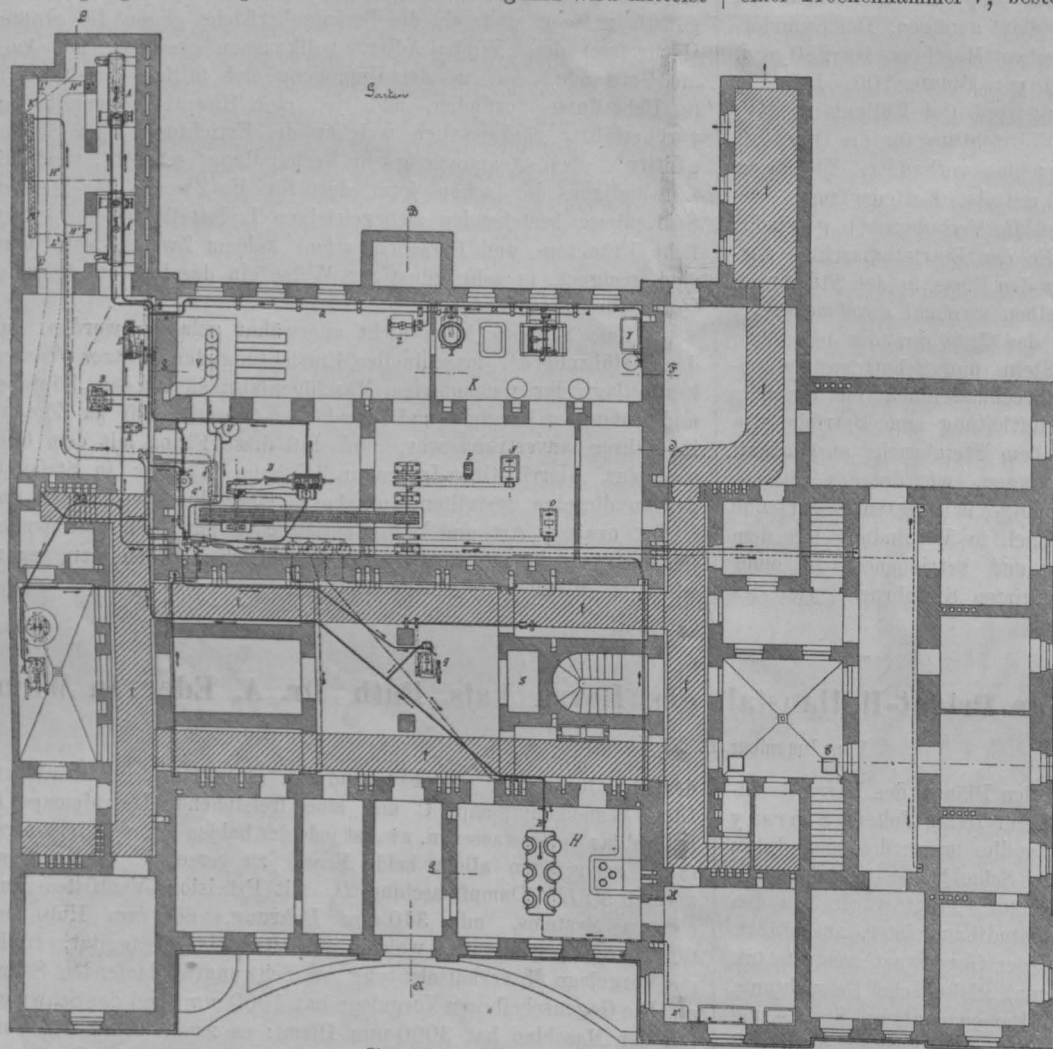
Grundriss des Souterrain 1:300.
